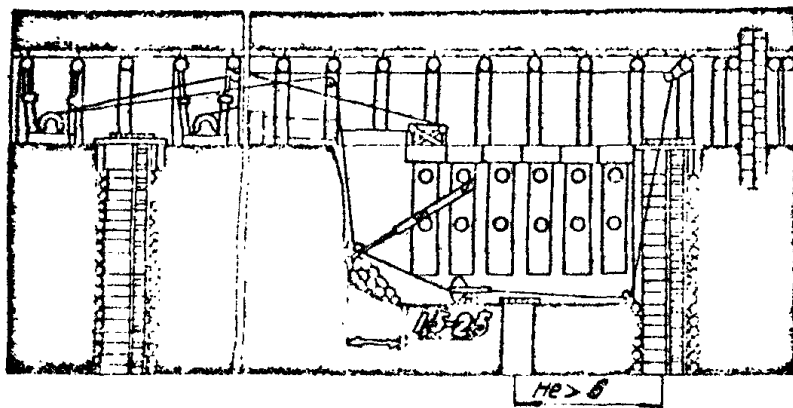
Схема монтажа агрегата IAUM на уровне вентиляционного впуска
